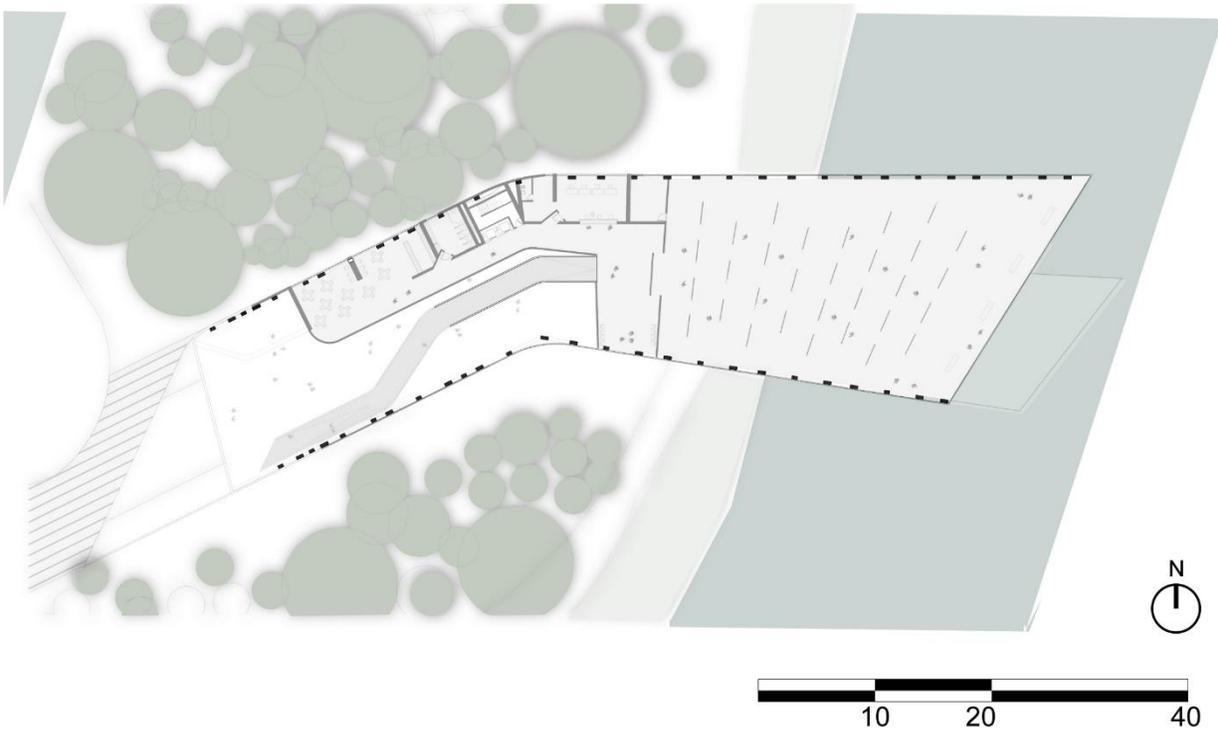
Intervención arquitectónica: “Muelle-Museo-Mirador”, planta alta.
